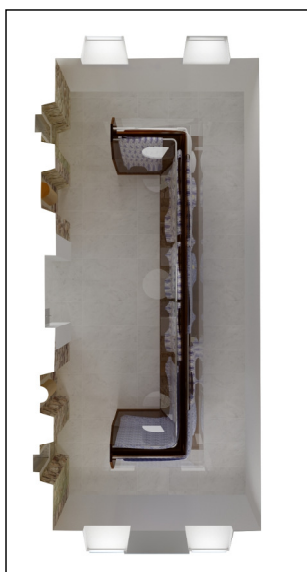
Planta 3d da loja de exposição permanente (Anexo 3)
